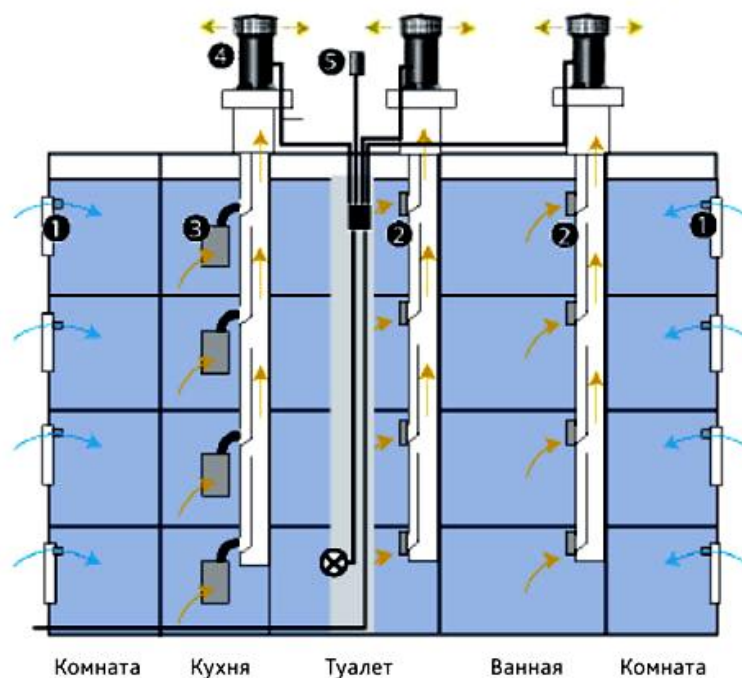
Схема гибридной вентиляции с низконапорными вентиляторами, устанавливаемыми на оголовок вентиляционного канала: 1 – приточное устройство, 2 – вытяжное устройство в санузлах, 3 – вытяжное устройство на кухне, 4 – вентилятор низкого давления, установленный на оголовок вентиляционной шахты, 5 – датчик температуры наружного воздуха и скорости ветра
